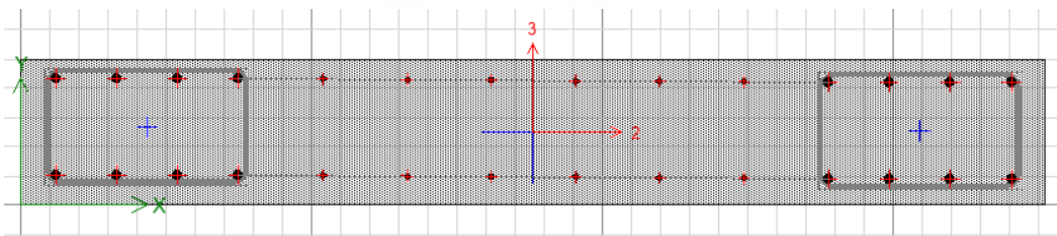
Distribución de acero prevista para la placa PL-02, primera propuesta de reforzamiento
